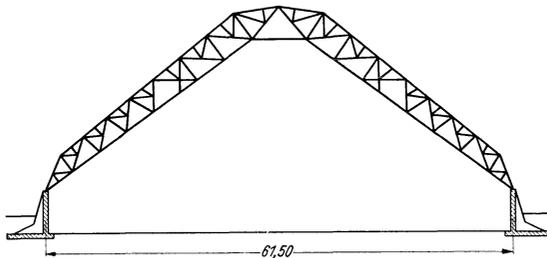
Bindersystem der Salzlagerrhalle Leunawerke, Merseburg.
